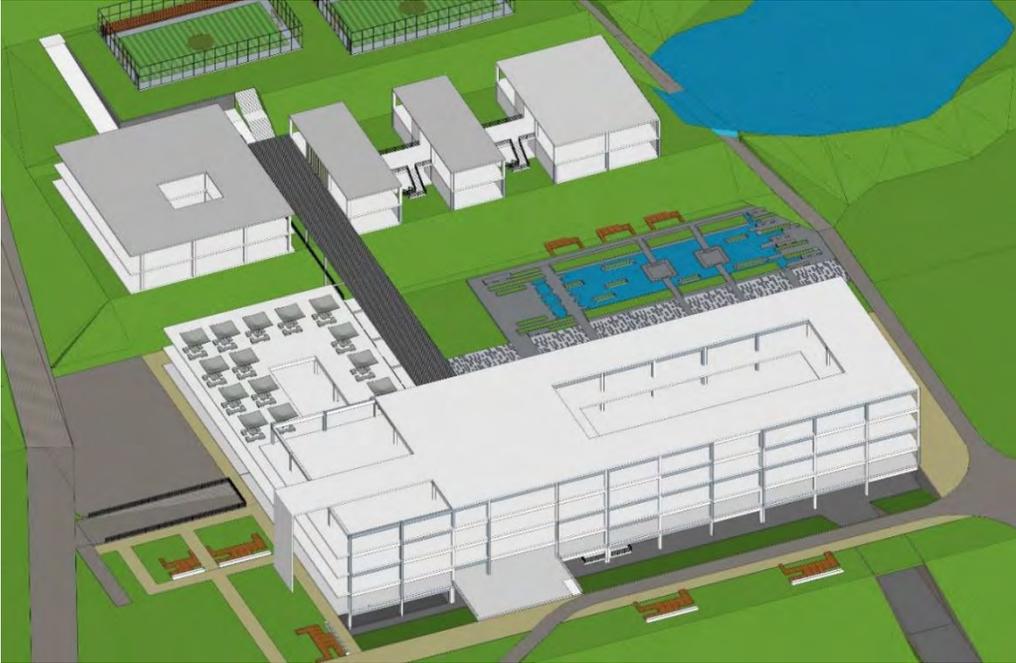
AXONOMETRIA ESTRUCTURAL
